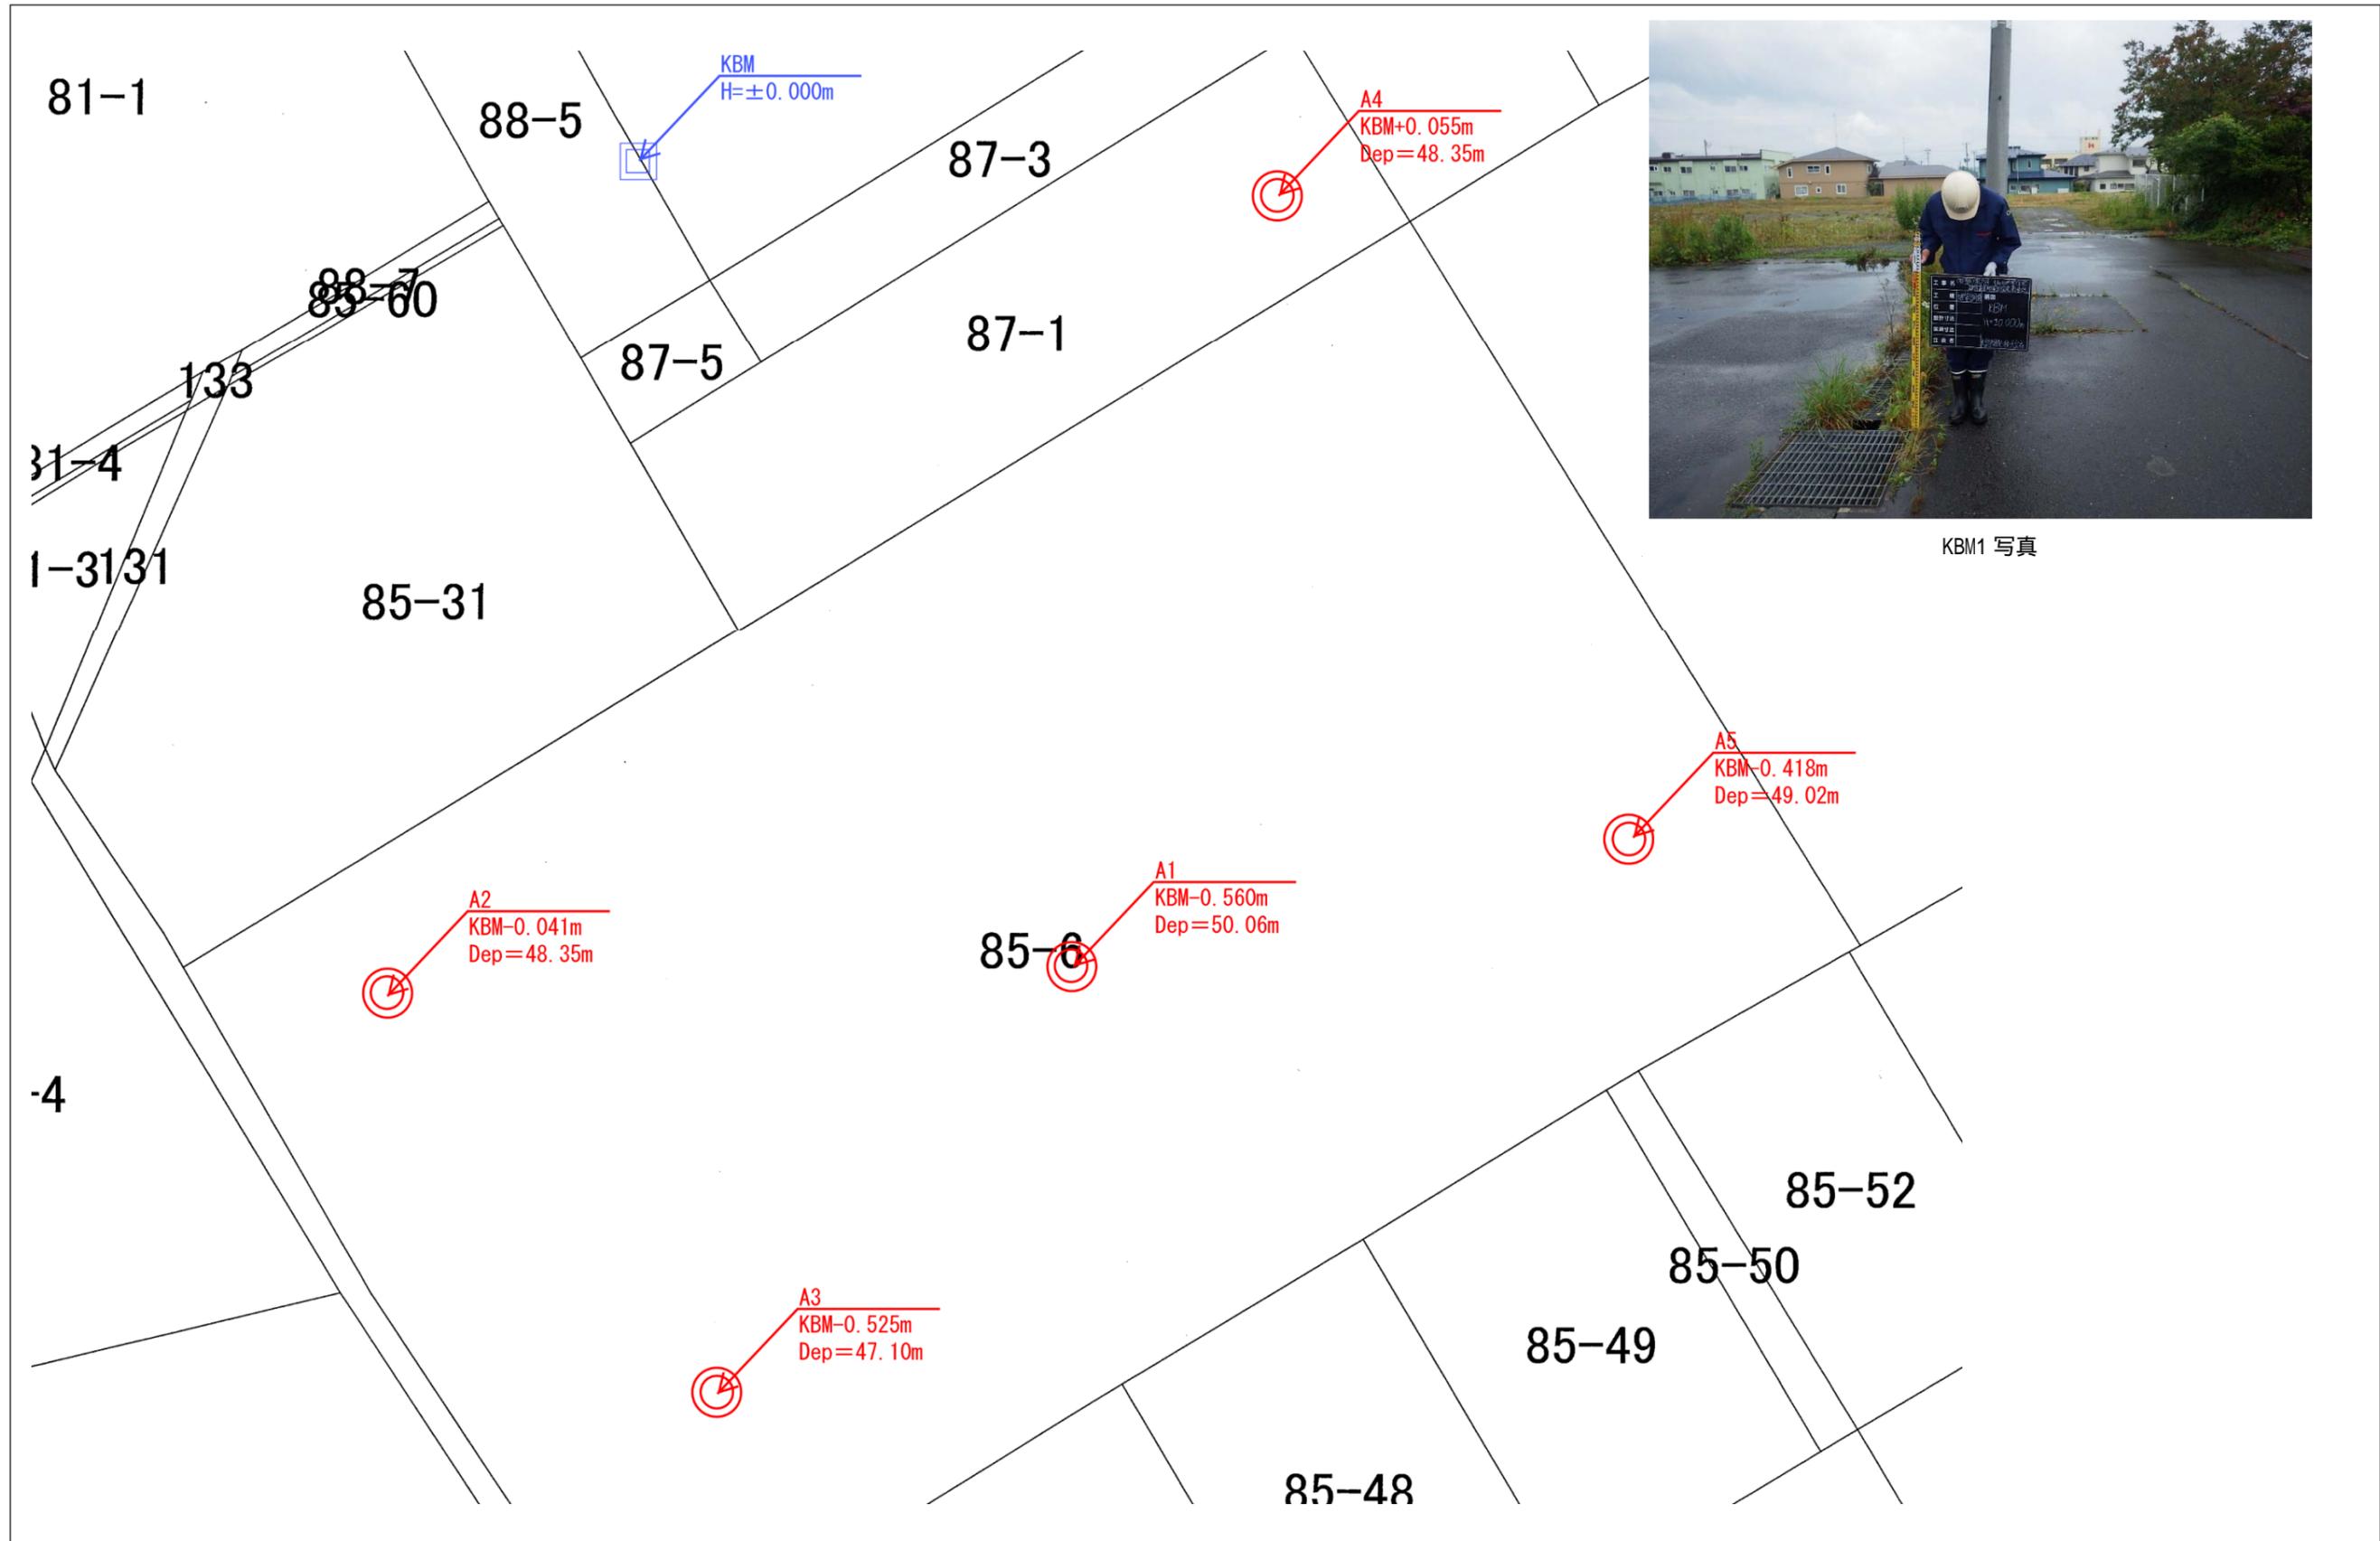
調査位置平面図 (地区 : S=1/300)
